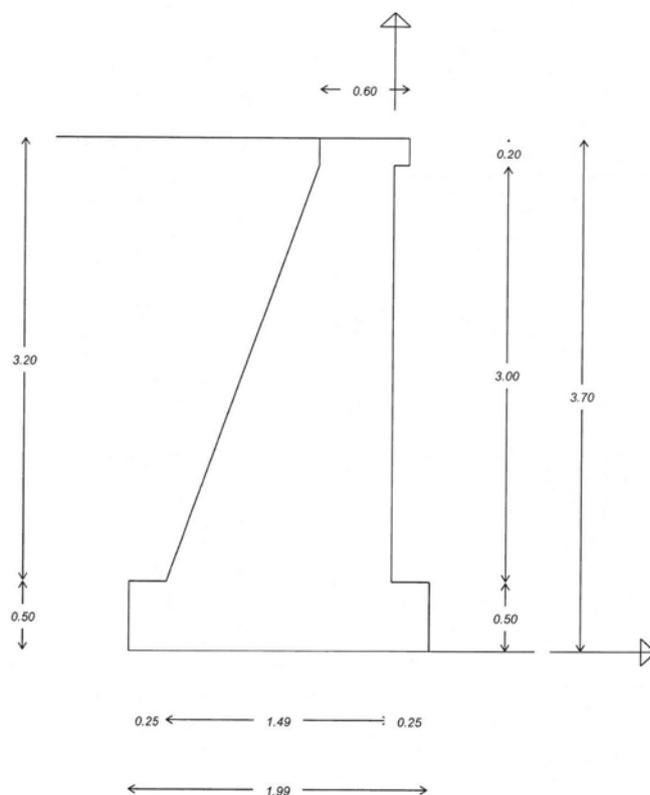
Esquema del muro en la hipótesis de altura máxima. Fuente: Desarrollo del Plan de Contingencia de abastecimiento en caso de rotura del Canal Bajo. caminos de acceso a las casetas 7 y 8
